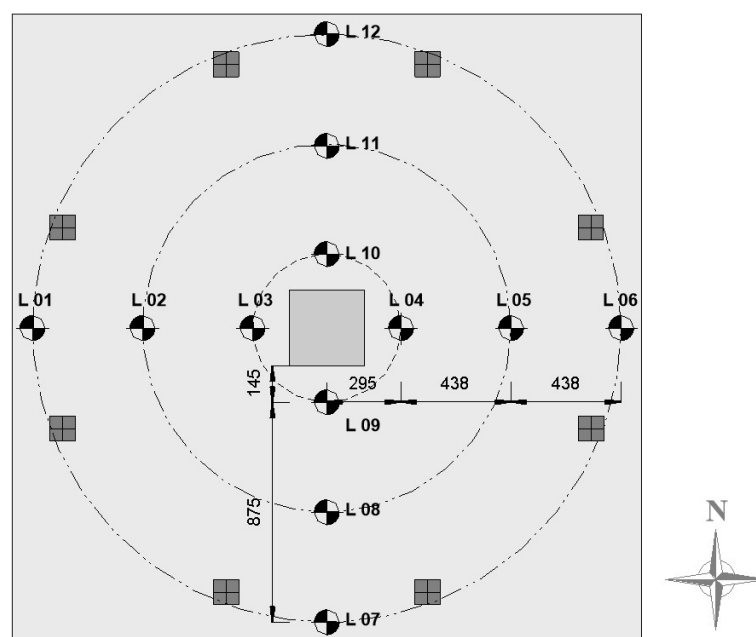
Vista em planta do posicionamento dos LVDT's (unidades em mm)
